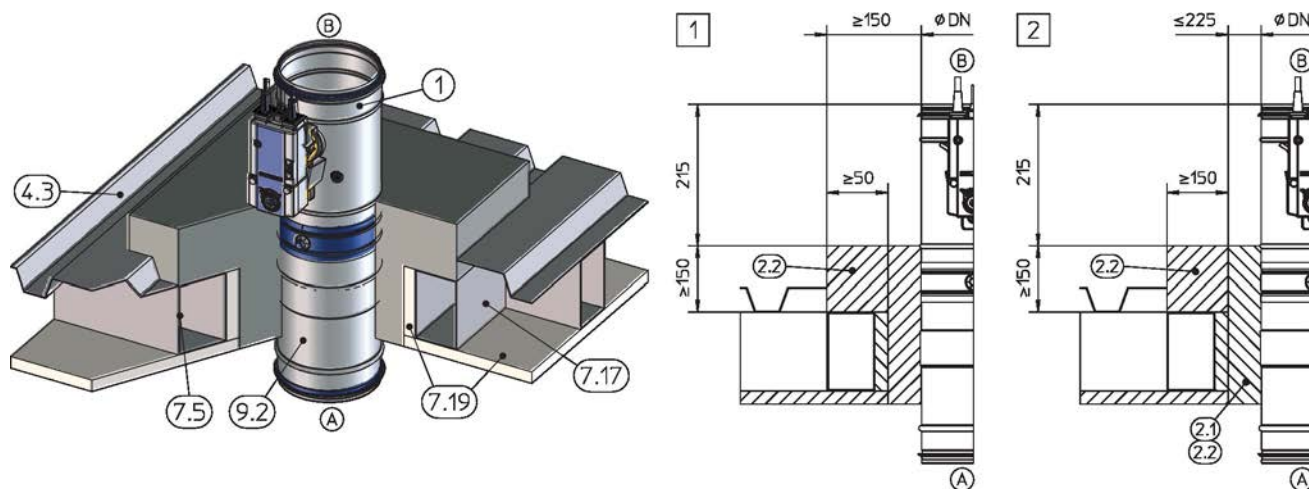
Монтаж с применением строительного раствора в сплошных перекрытиях по деревянным / клееным деревянным балкам, на рисунке показано вертикальное расположение (также применимо для монтажа на подвесах)
